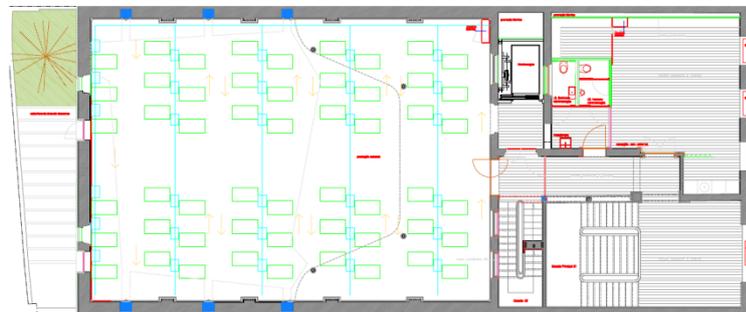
Planta do Piso 1 (Cota 104,30 m)
